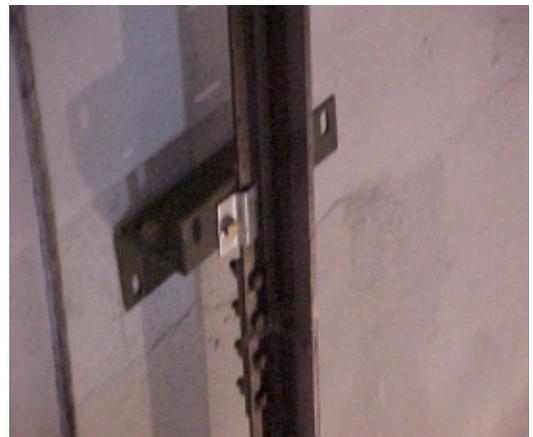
Vista superior da estrutura executada e detalhe da fixação na viga da caixa
